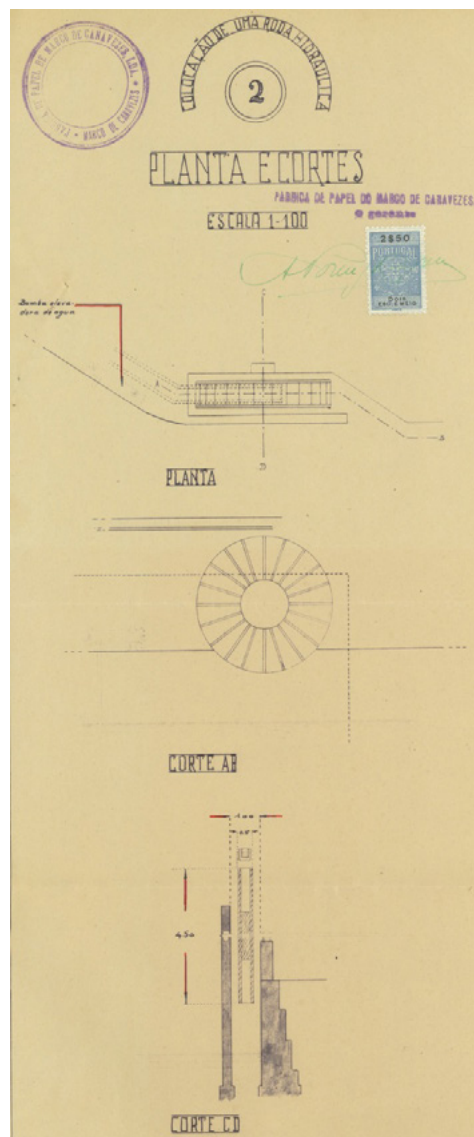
Planta e cortes da nova roda hidráulica, com a potência de 10 HP. Esc.: 1:100.
